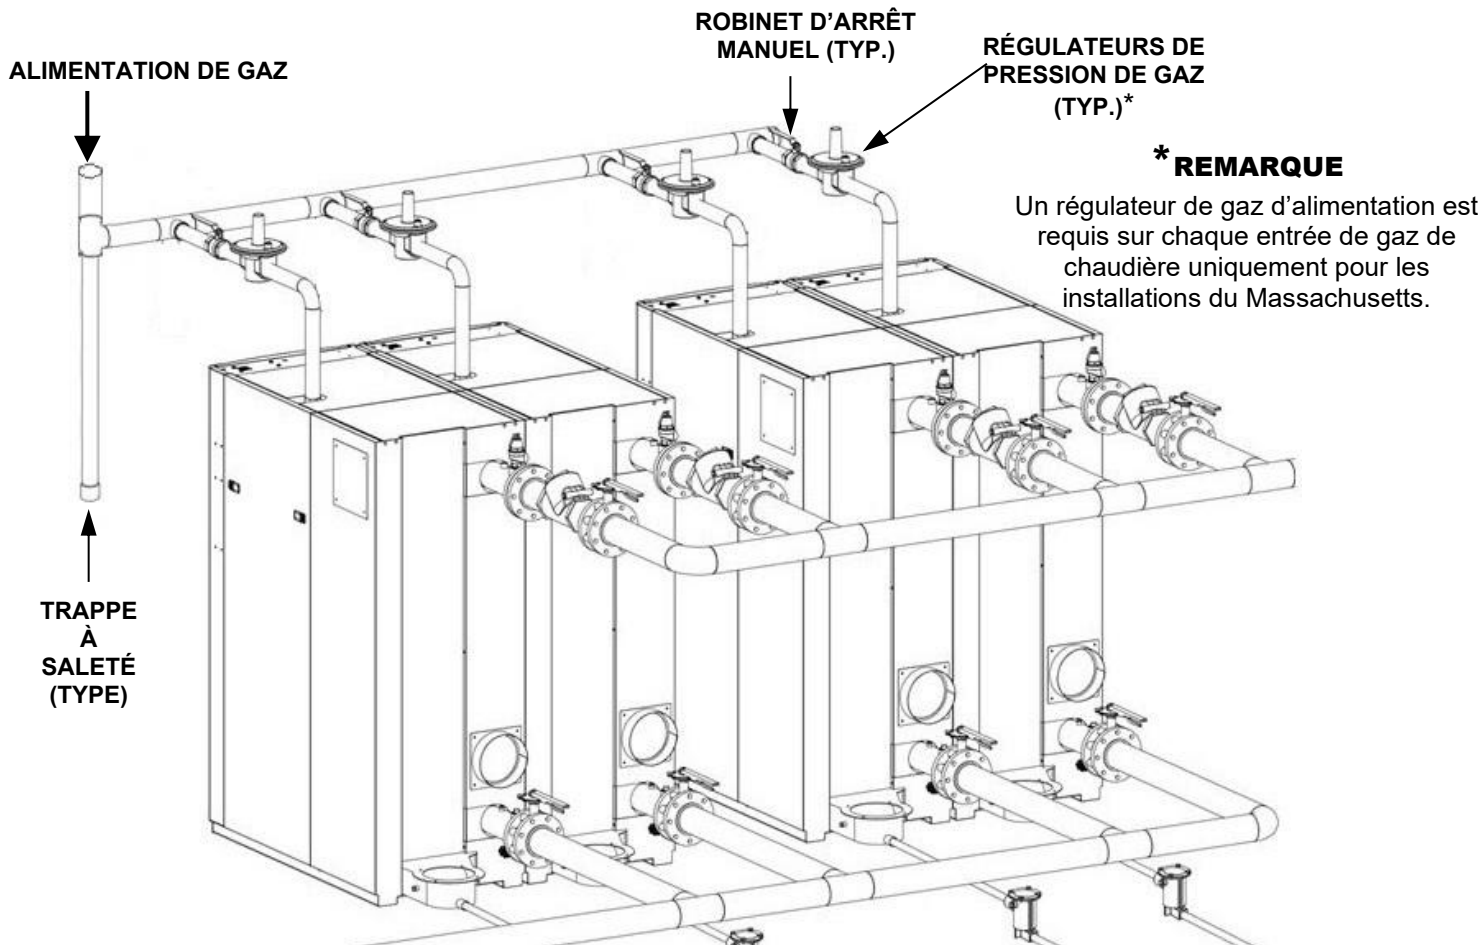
Construction type d'un collecteur pour chaudières multiples
